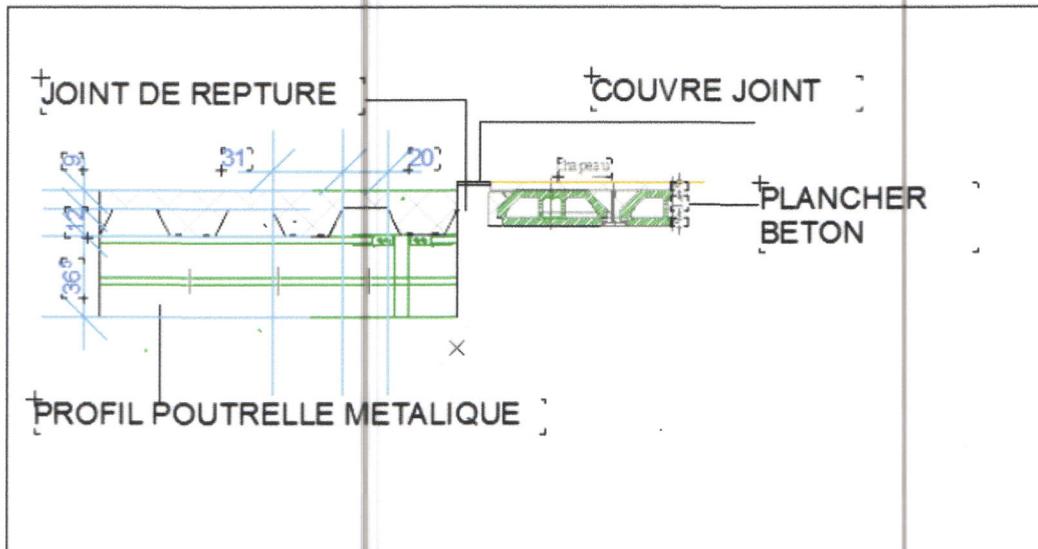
Détail d'assemblage plancher collaborant /plancher béton
